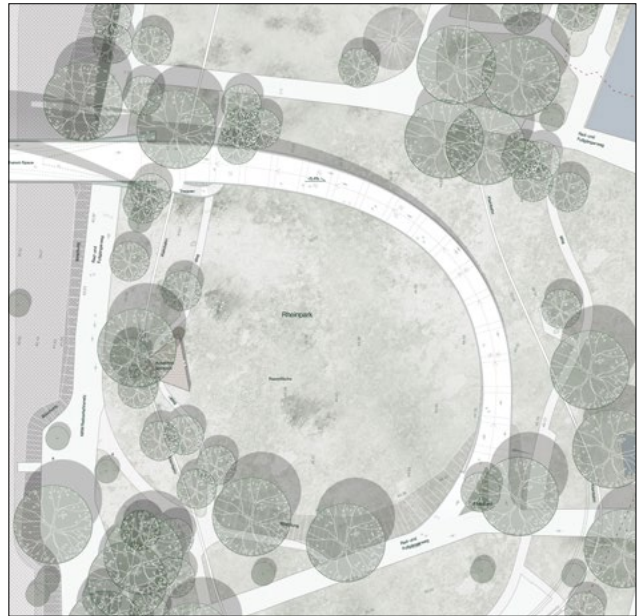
Grundriss rechtsrheinische Rampe
